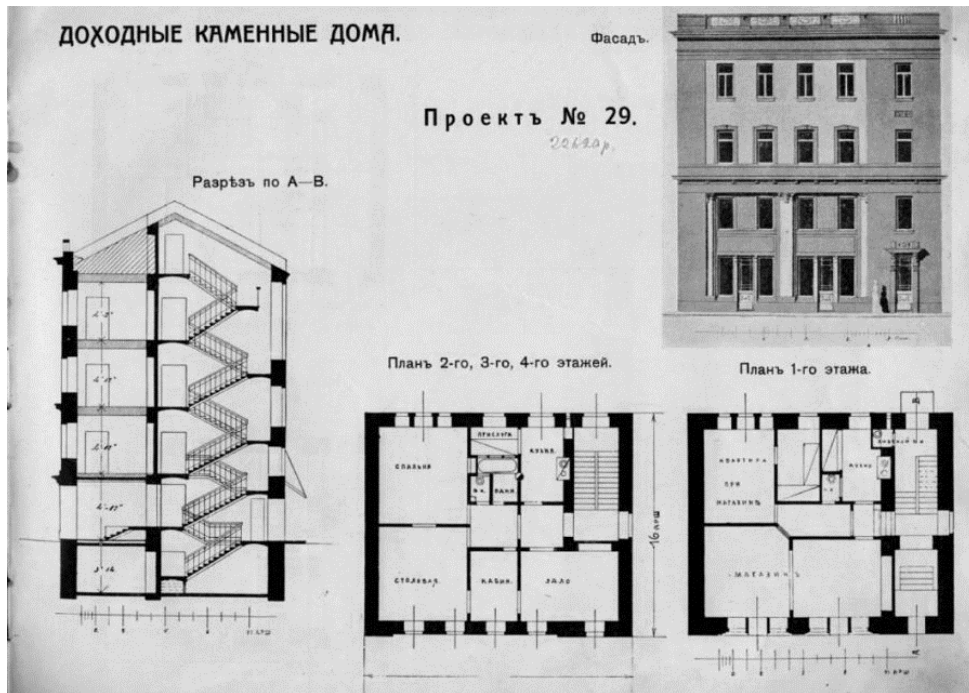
Из каталога образцовых типовых решений каменных доходных домов. Проект №29. Фасад, Разрез в осях А-В, поэтажный план 1-4 этажей.
